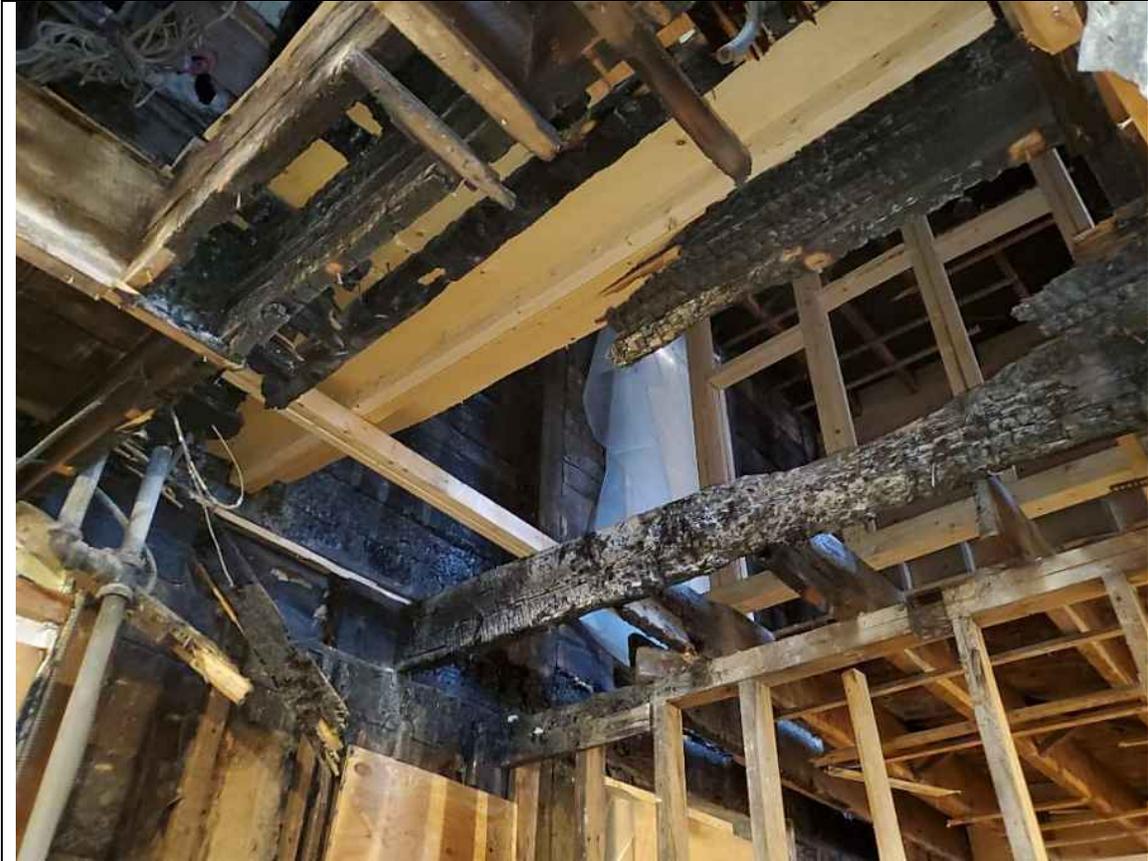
Structure partielle de plancher endommagé; les solives ne retiennent plus le mur du carré de bois.
